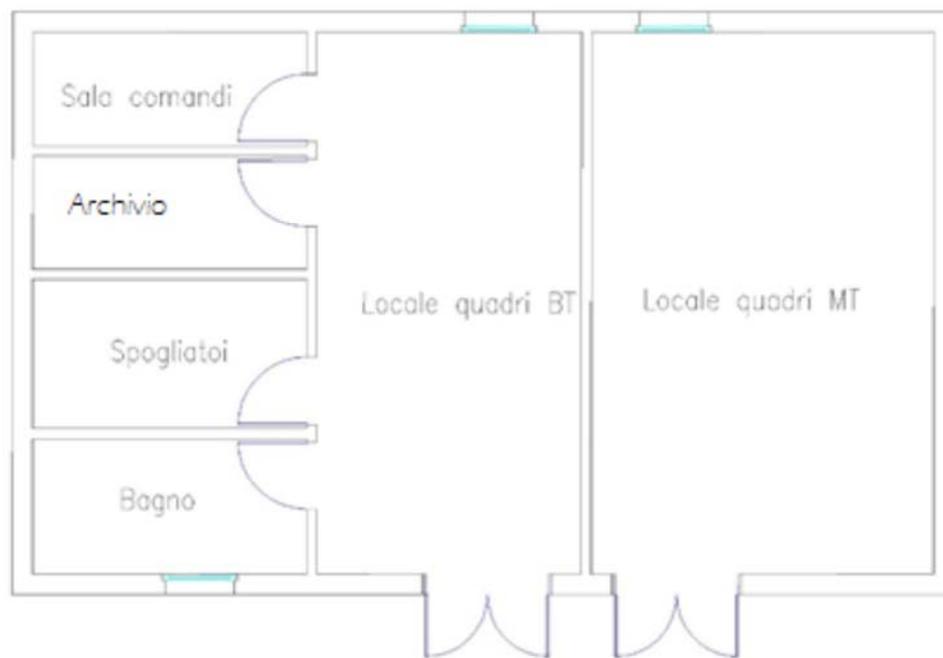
Planimetria locale dedicato a impianto di accumulo (BESS)
